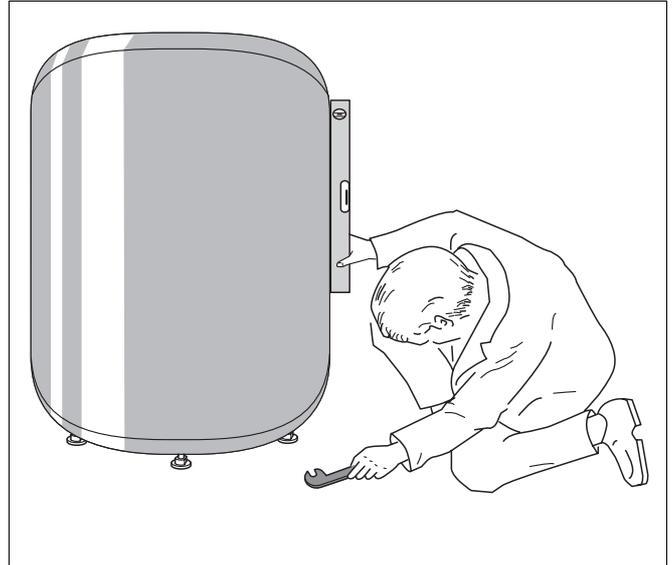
Justieren der Fußschrauben (Prinzipabbildung)
